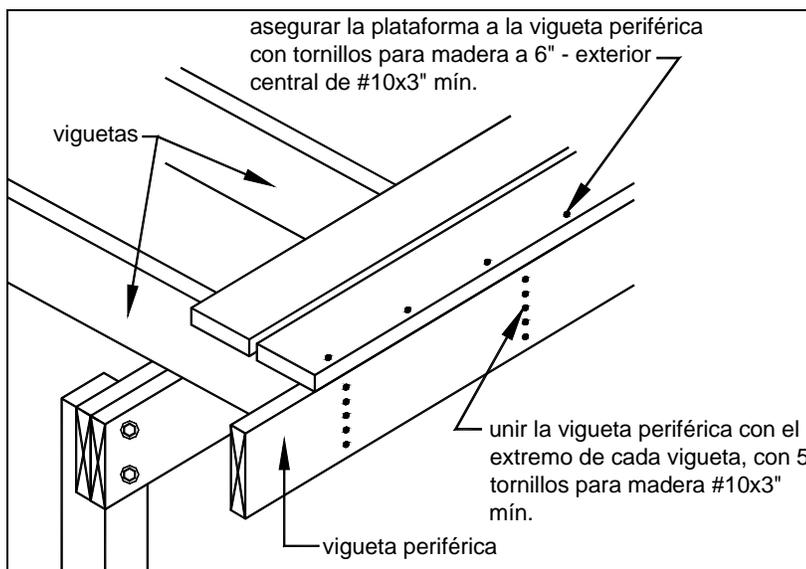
DETALLE SOBRE LA UNIÓN DE VIGUETAS PERIFÉRICAS
